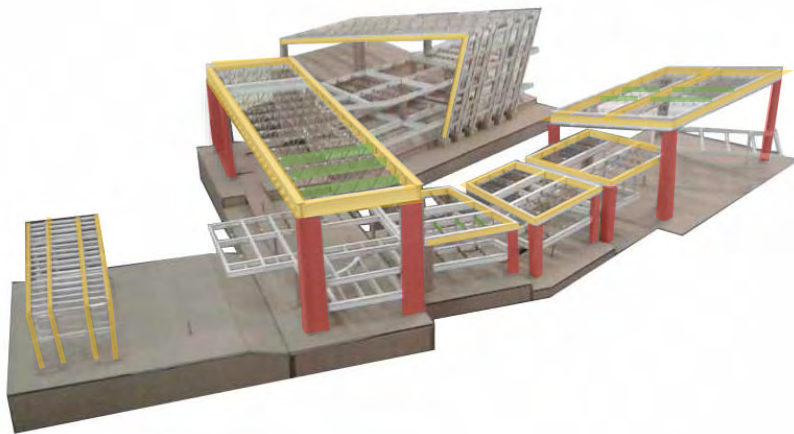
Fotografía maqueta estructural 2. Fuente: Elaboración propia
